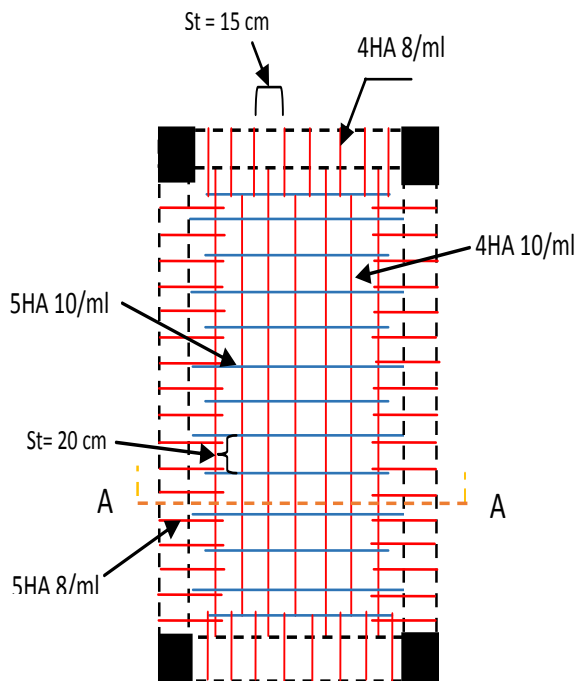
schémas de ferrailage de la dalle du RDC (4 appuis)
